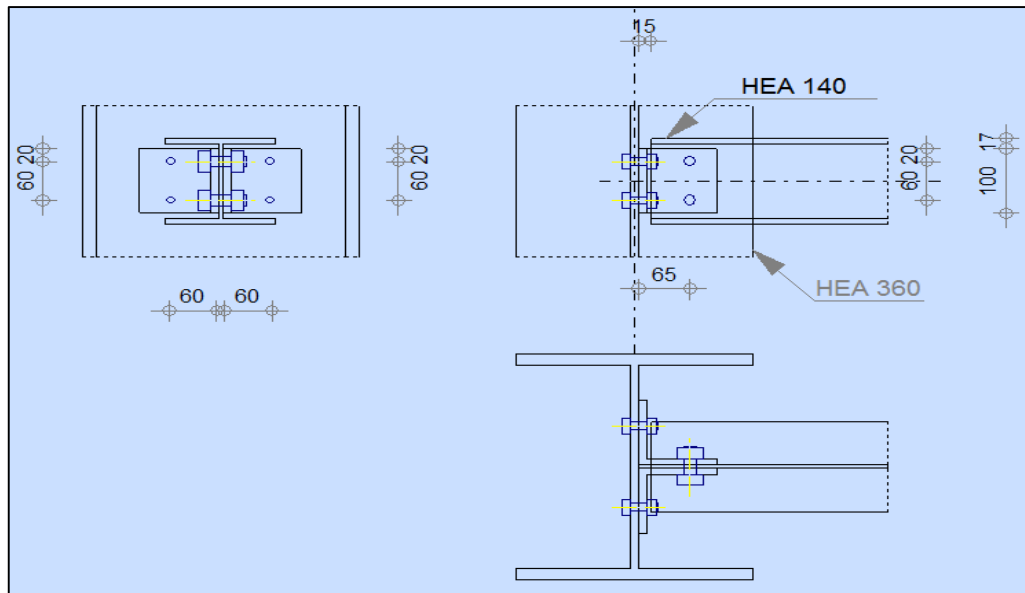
Vue en Plan de l'assemblage poteau - sablière.
